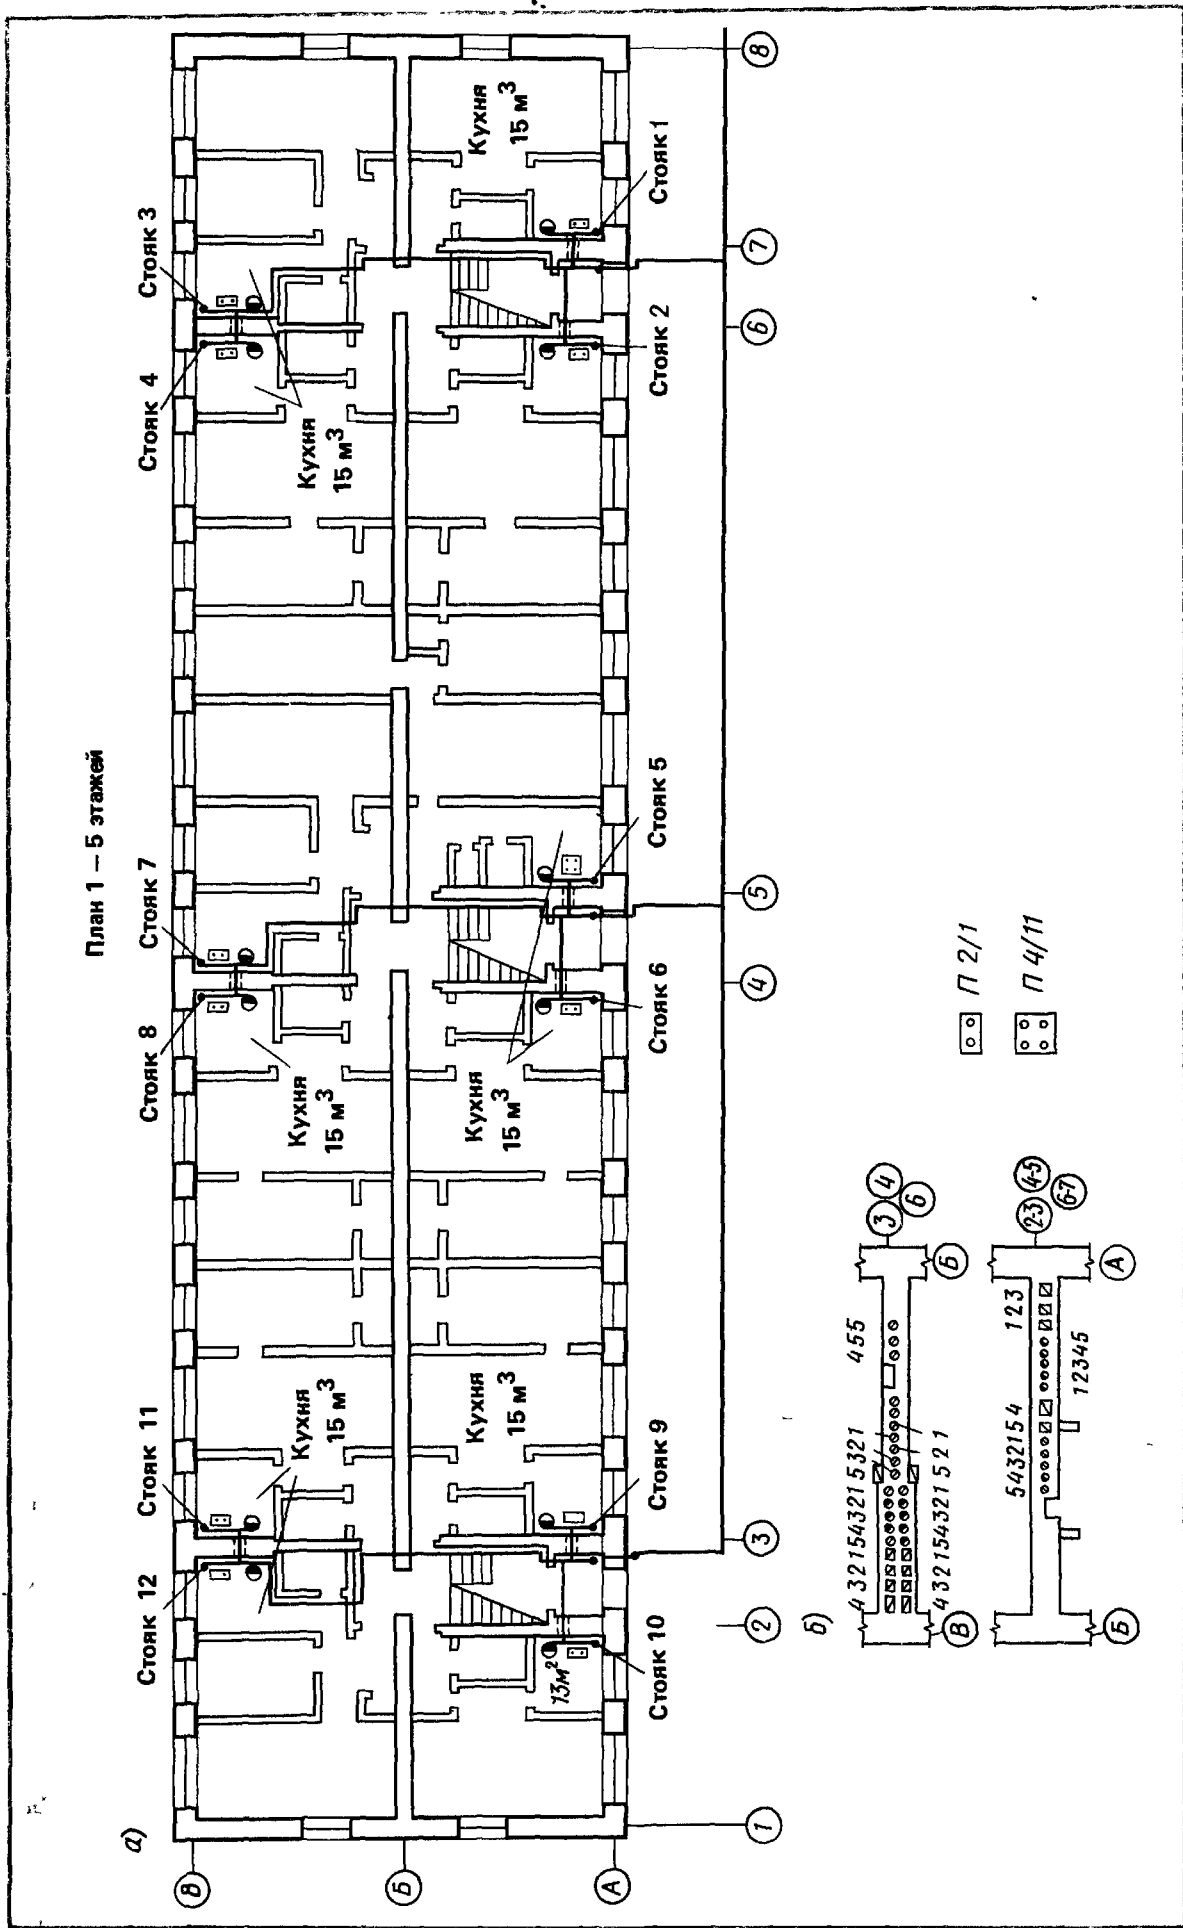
Схема газоснабжения пятиэтажного жилого дома
